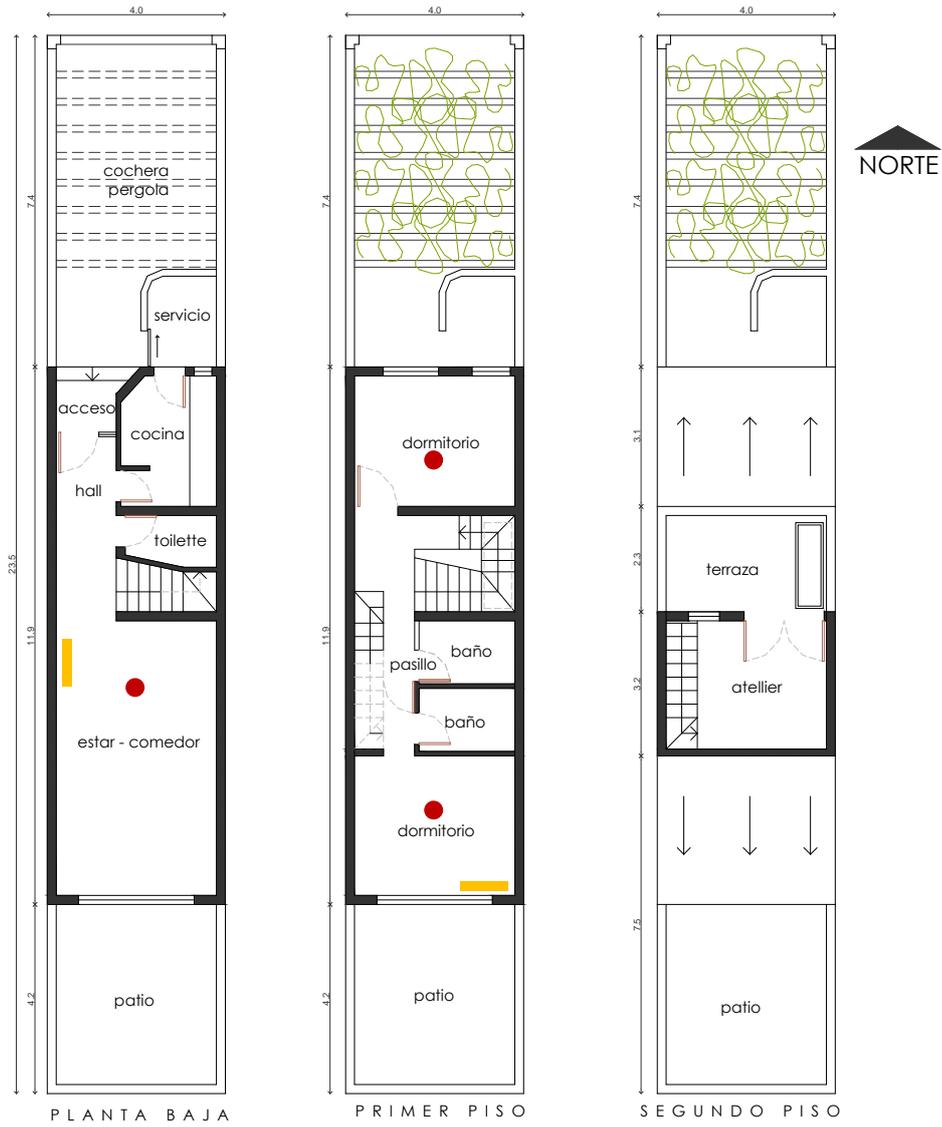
Plantas de la vivienda. Fuente: Planos municipales conforme a obra.
